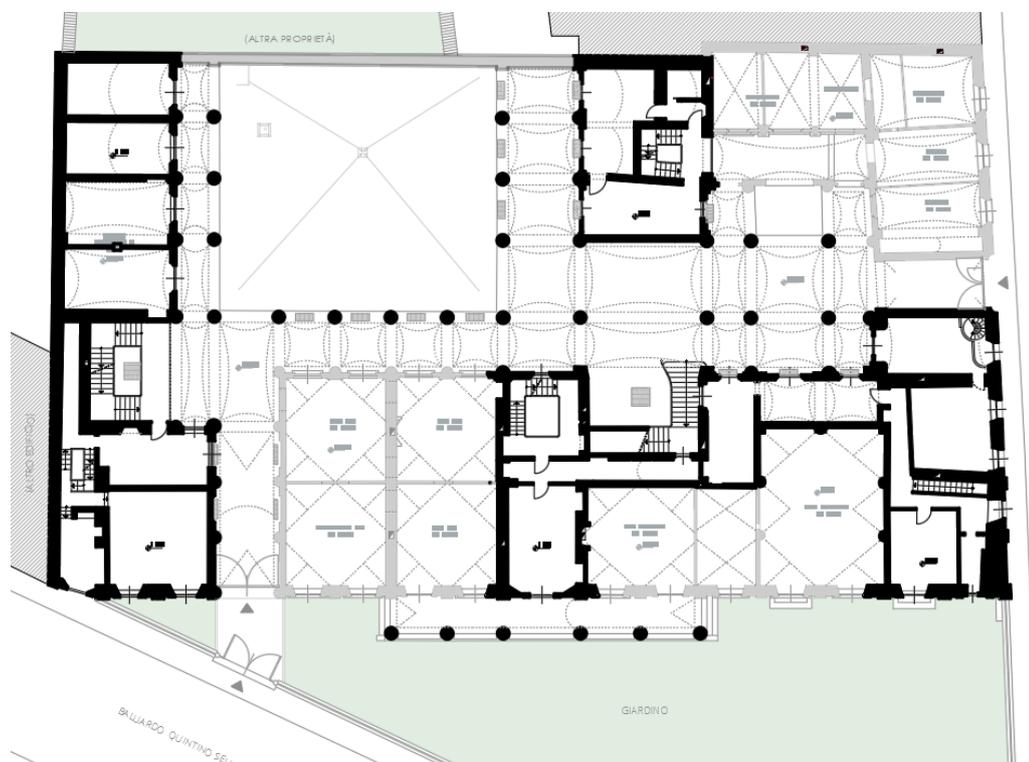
Pianta del Piano ammezzato. Fuori scala.
